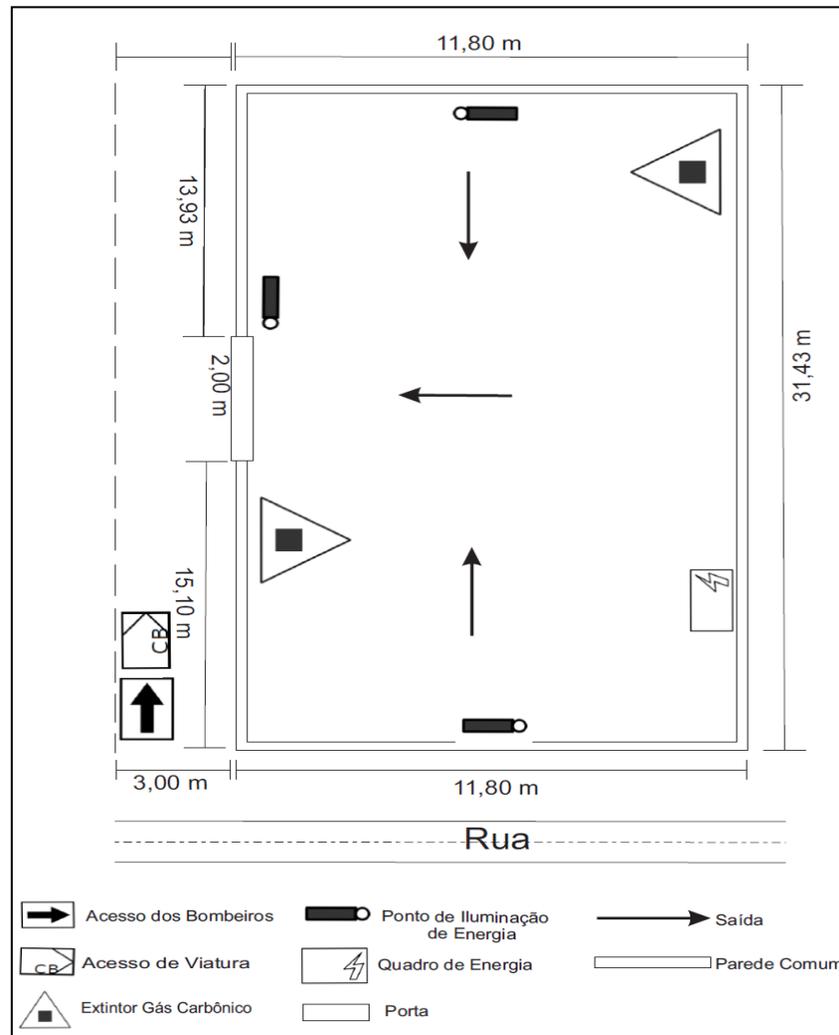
Planta Baixa da Localização dos Extintores.
